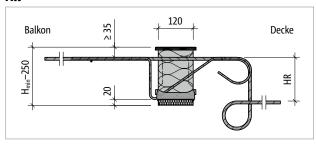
Schöck Isokorb® XT Typ K-BH: Produktschnitt
